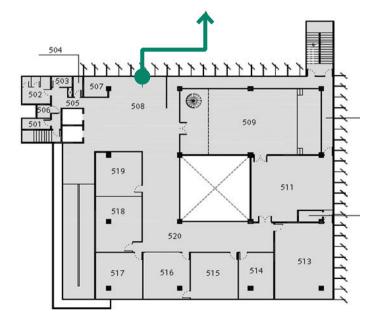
Planta Baixa pavimento 05 do Prédio de vidros. Fonte: levantamento realizado pela consultora.
